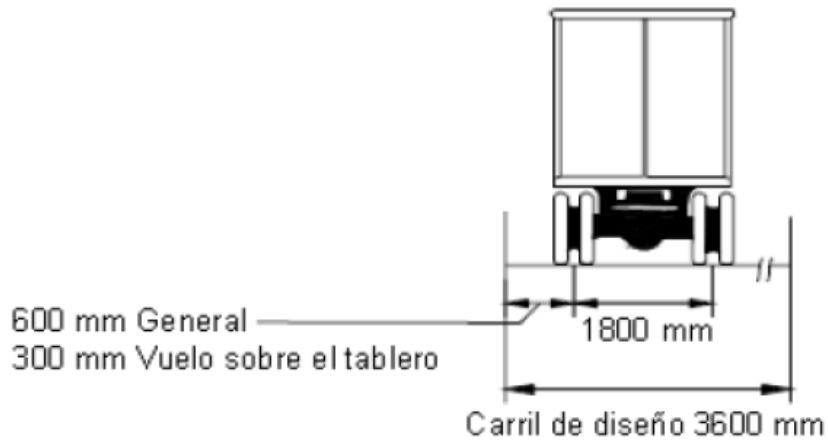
SEPARACIÓN TRANSVERSAL DE RUEDAS
